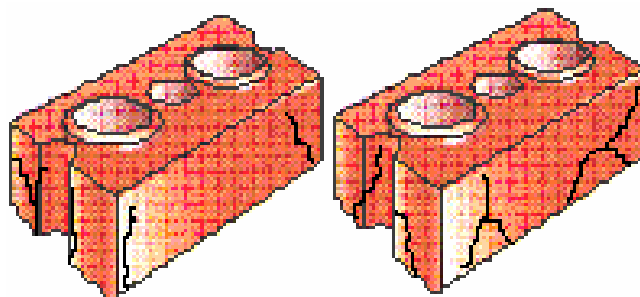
Bloco TJ 110 com a fissuração típica nas faces norte, oeste, sul e leste
